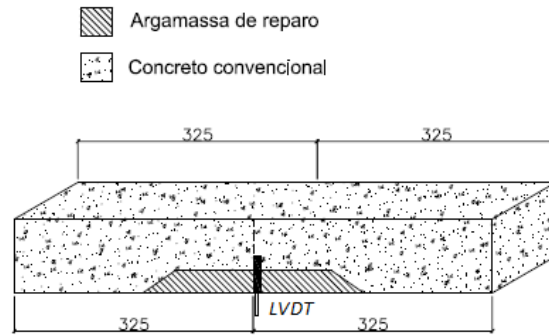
Posicionamento do LVDT nas vigas (dimensões em mm).
